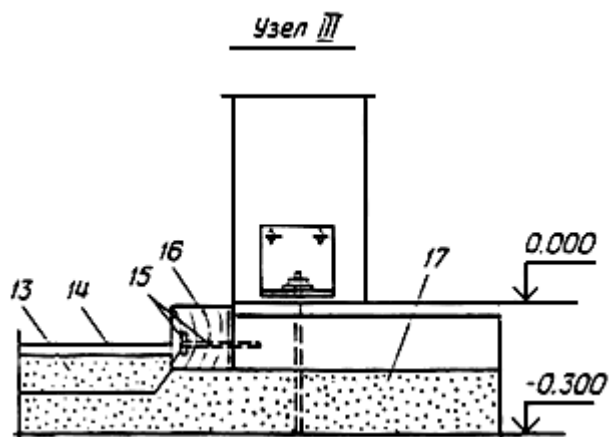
Схема организации строительной площадки (вариант I), узел III
